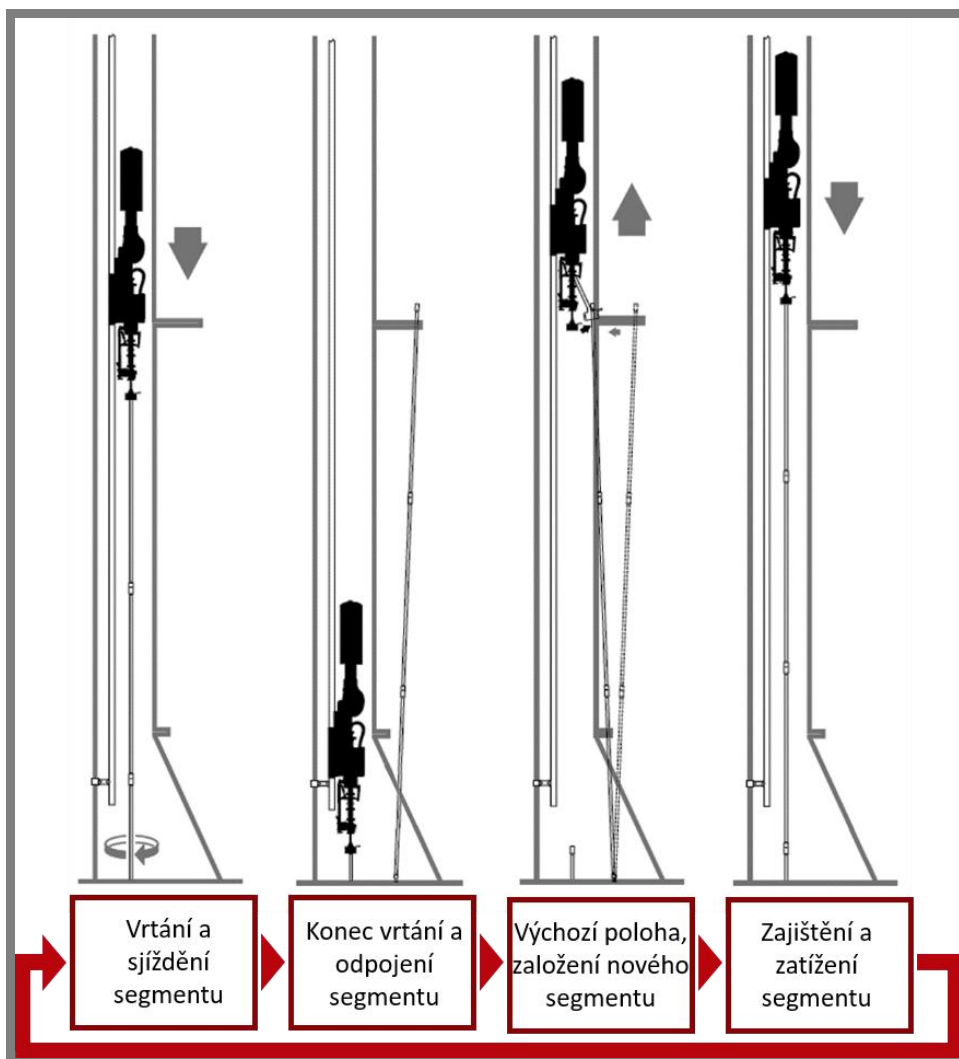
Systém rotační hlavy Top Drive [5]
